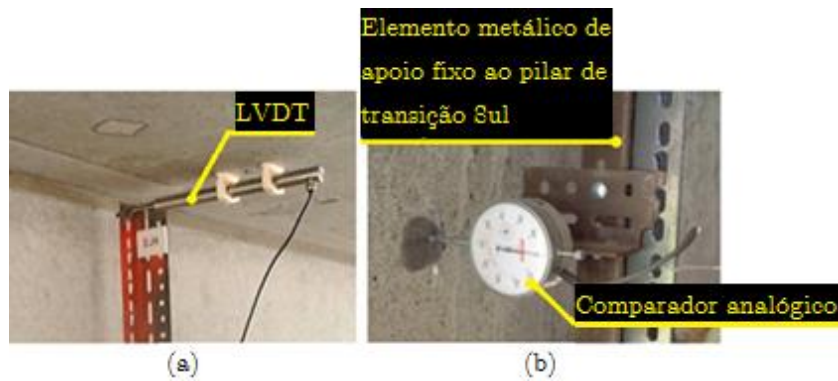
(a) Pormenor de um LVDT instalado no pilar PT-N; (b) Comparador analógico instalado no pilar PT-S (LABEST/FEUP, 2005).
